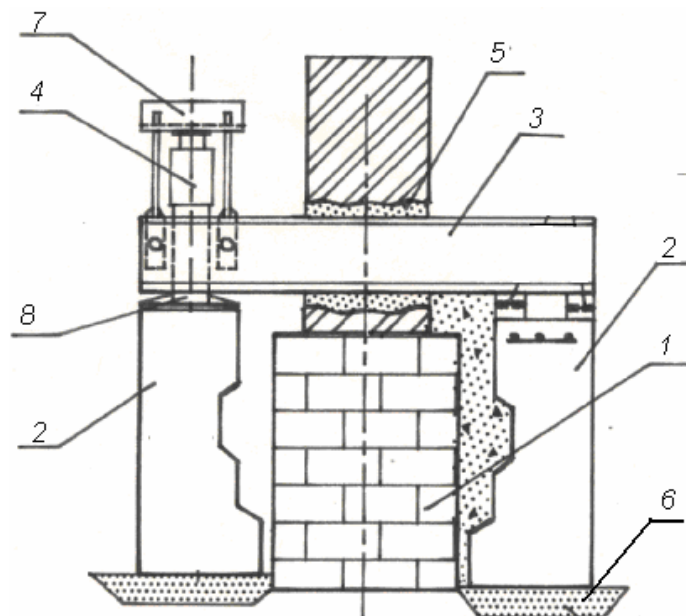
Уширение подошвы фундамента с предварительным обжатием грунтов гидравлическими домкратами: 1 – существующий фундамент, 2 – банкетки, 3 – опорная балка, 4 – домкрат, 5 – мелкозернистый бетон замоноличивания, 6 – щебеночно-песчаная подготовка, 7 – инвентарный упор, 8 – штамп
